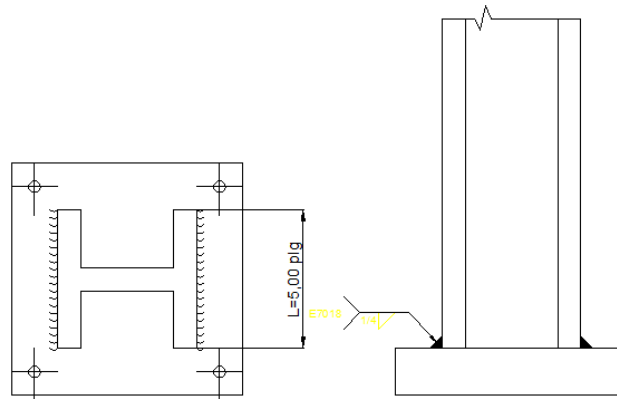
16: Esquema de dimensión de la soldadura.
